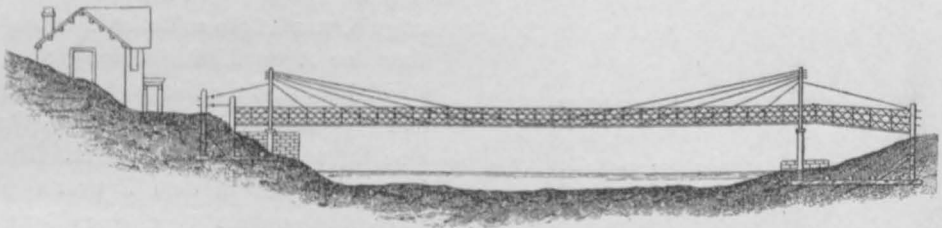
Kings-Meadow-Brücke (nach NAVIER). 1871.
